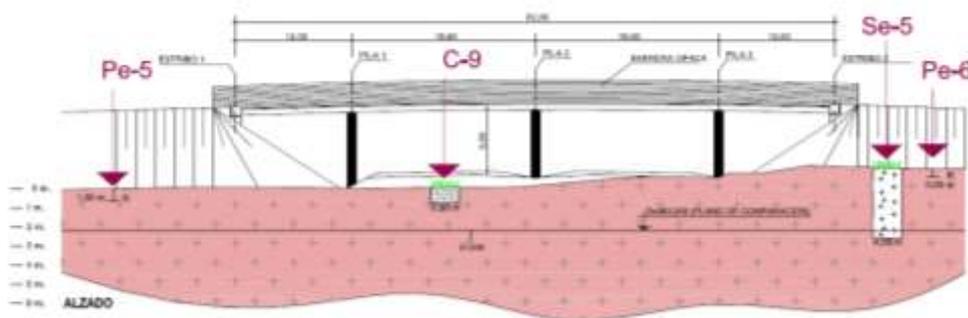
Perfil estratigráfico del emplazamiento. Fuente: Proyecto Original
